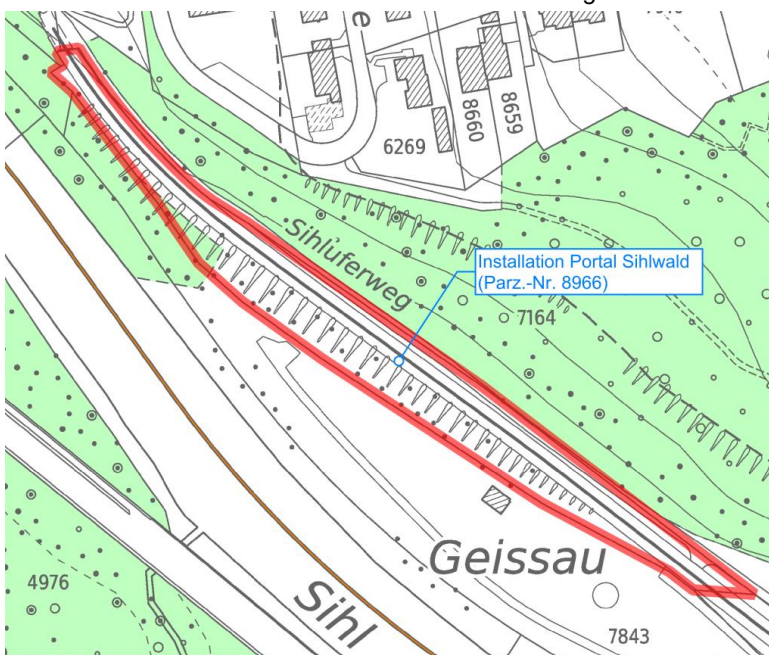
Grundstück SZU für Installation bei Portal Sihlwald
